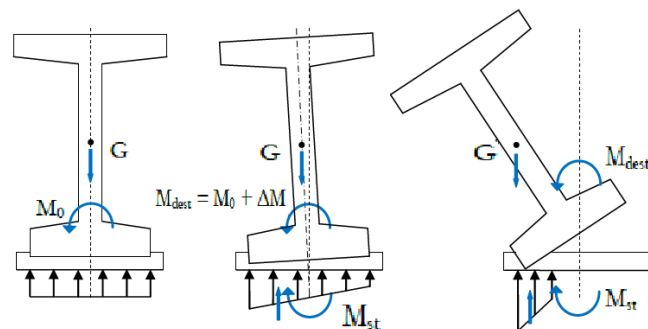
Viga com imperfeições sobre apoio elastomérico. (a) configuração inicial sujeita a um momento de tombamento devido à excentricidade lateral, b) viga após rotação, c) falha por tombamento)
